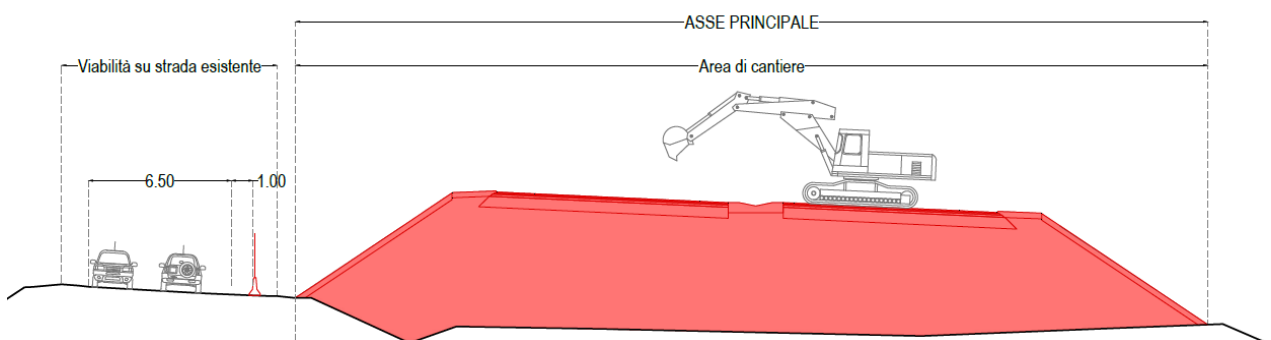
Sez. fase 1 asse principale, le lavorazioni non interferiscono con la sede stradale attuale
